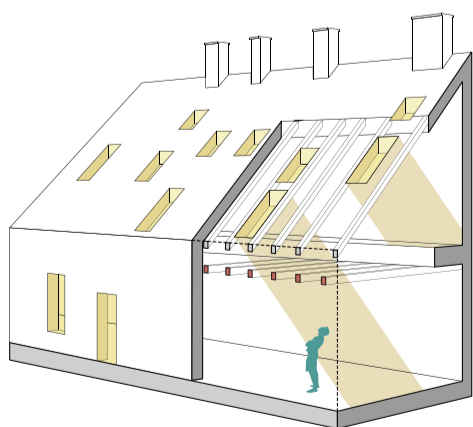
›Spiegeln‹ der alten Dachkonstruktion
